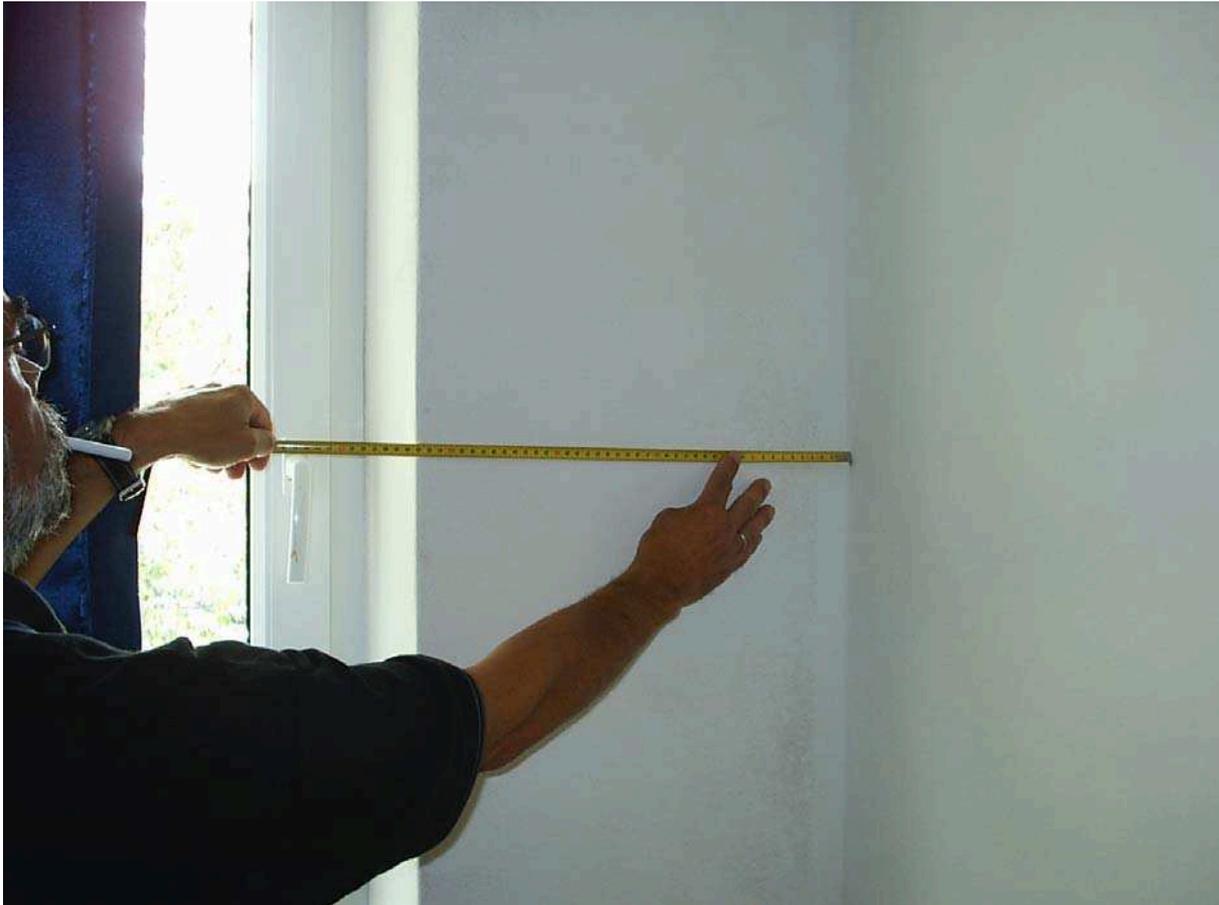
Innenaufnahme AW Schlafzimmer – „Gerätemontage gut möglich“
